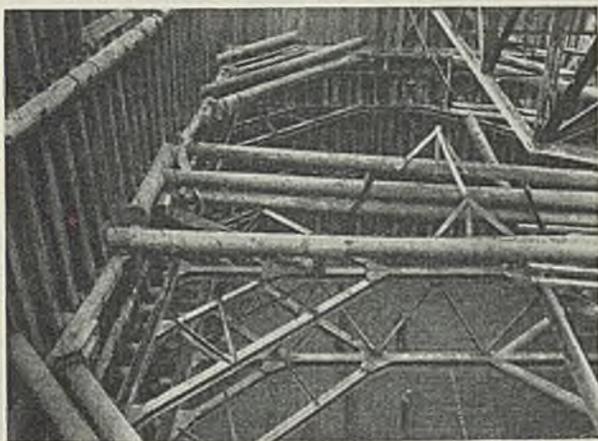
Aussteifung der Baugrube des westlichen Torpfeilers am Außenhaupt.
